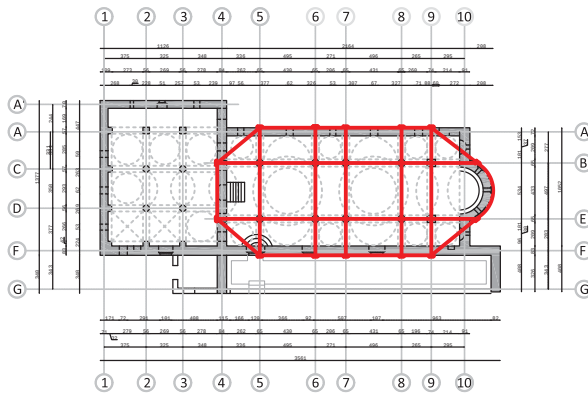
Skema e përforsimit të tirantave ekzistuese me elemente metalike
